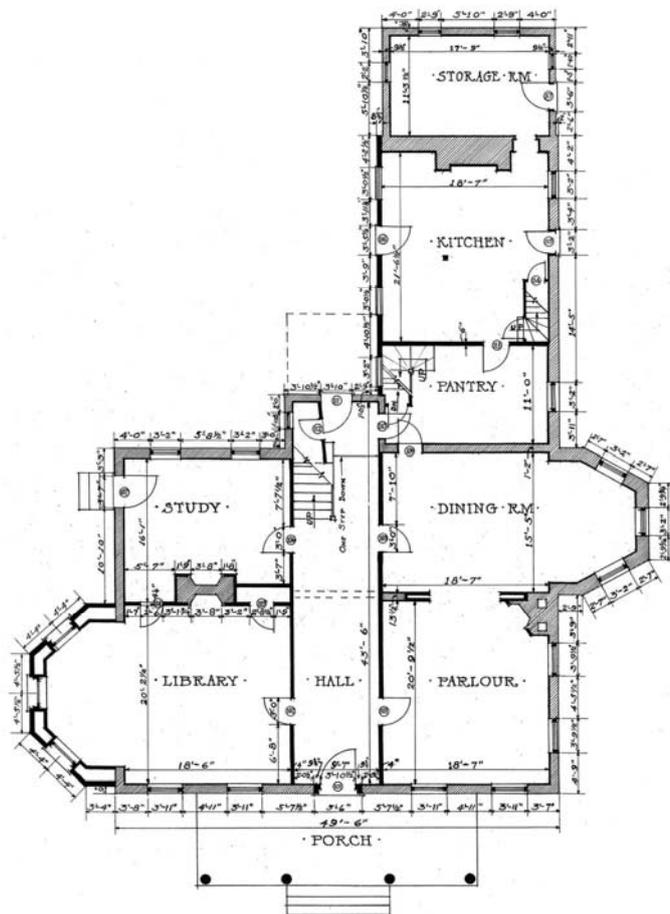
4: Haus des Präsidenten, Grundriss
